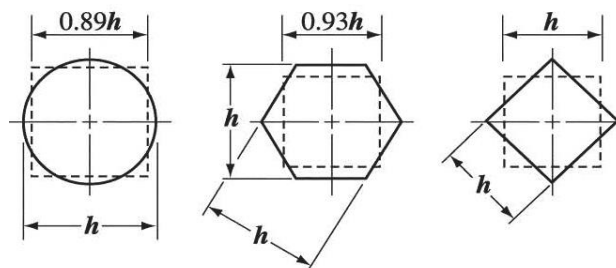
Ejemplos de secciones cuadradas equivalentes para columnas de apoyo.
